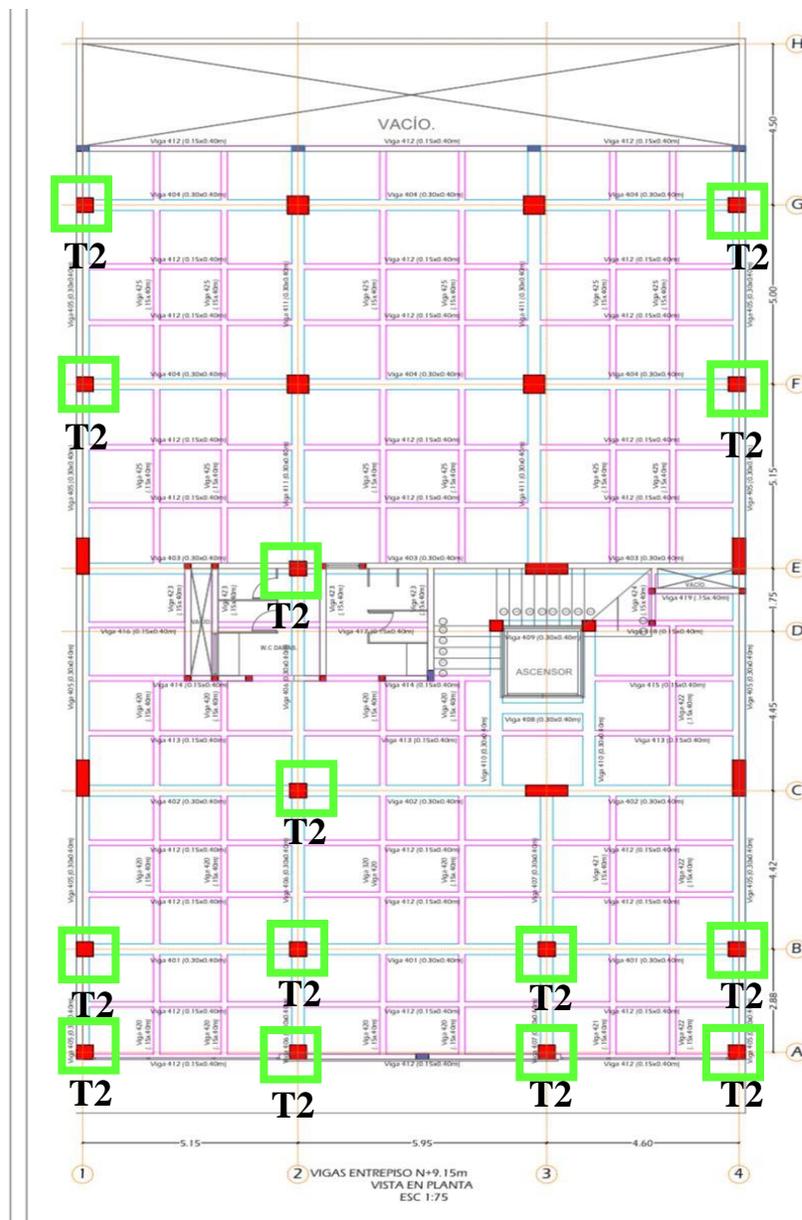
Vigas, columnas y columnetas vistas en planta.
